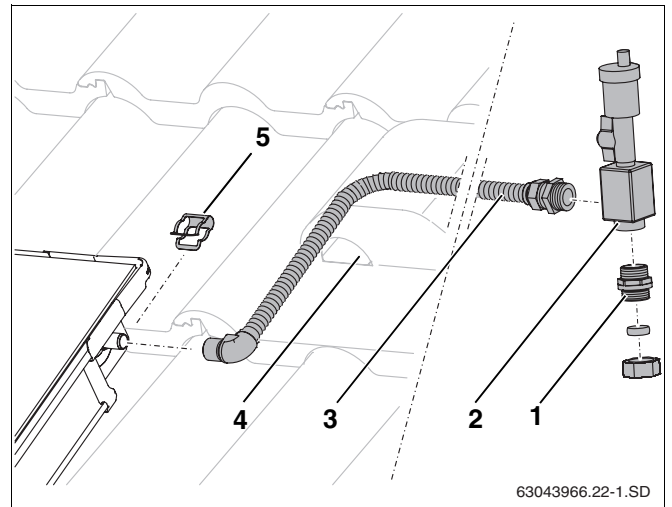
Instalar o dispositivo de purga por baixo do telhado
